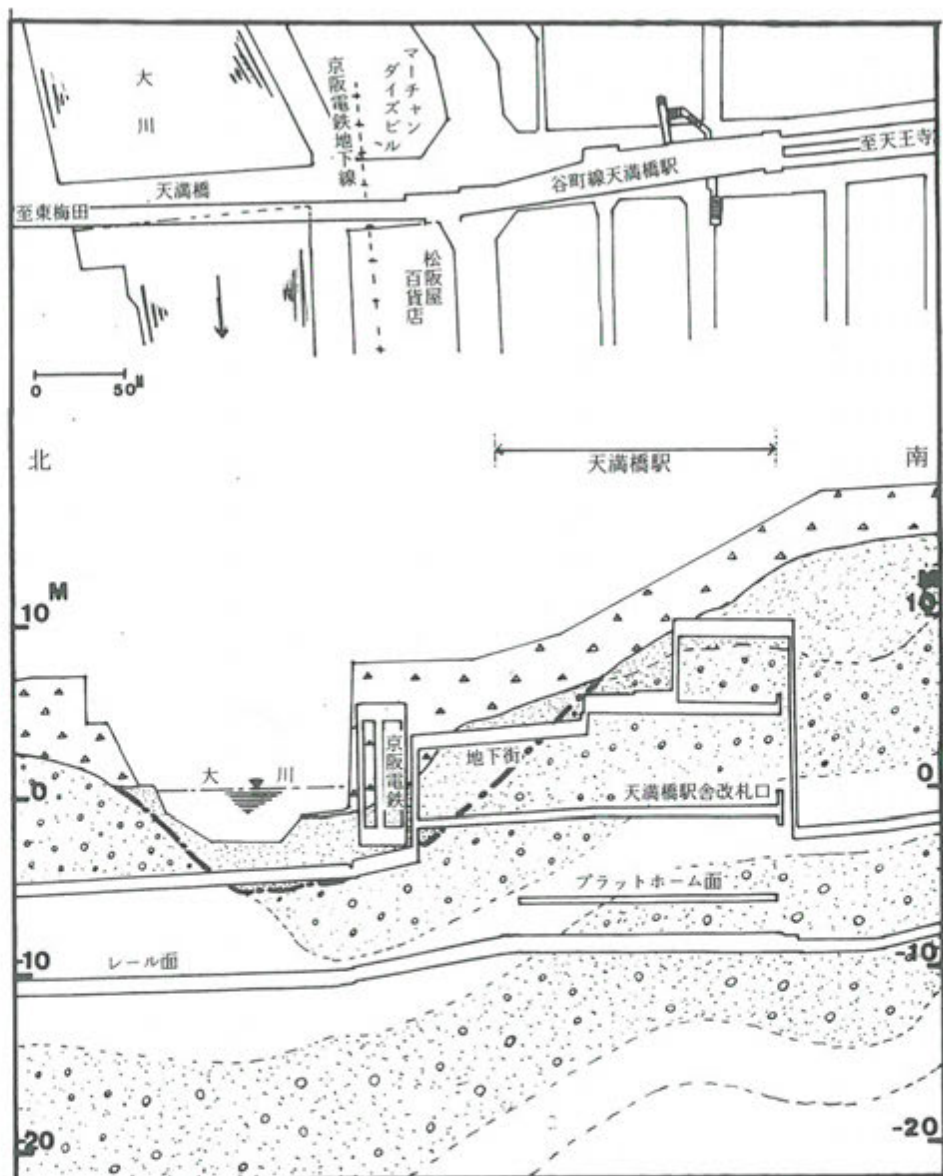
地下鉄天満橋駅付近の平面図と断面図（凡例は図2参照）
